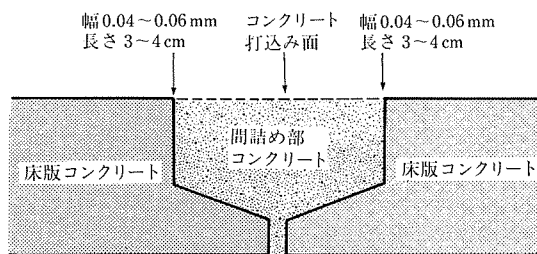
打継ぎ部のひび割れ (材齢 91 日における早強コンクリートのひび割れ)
